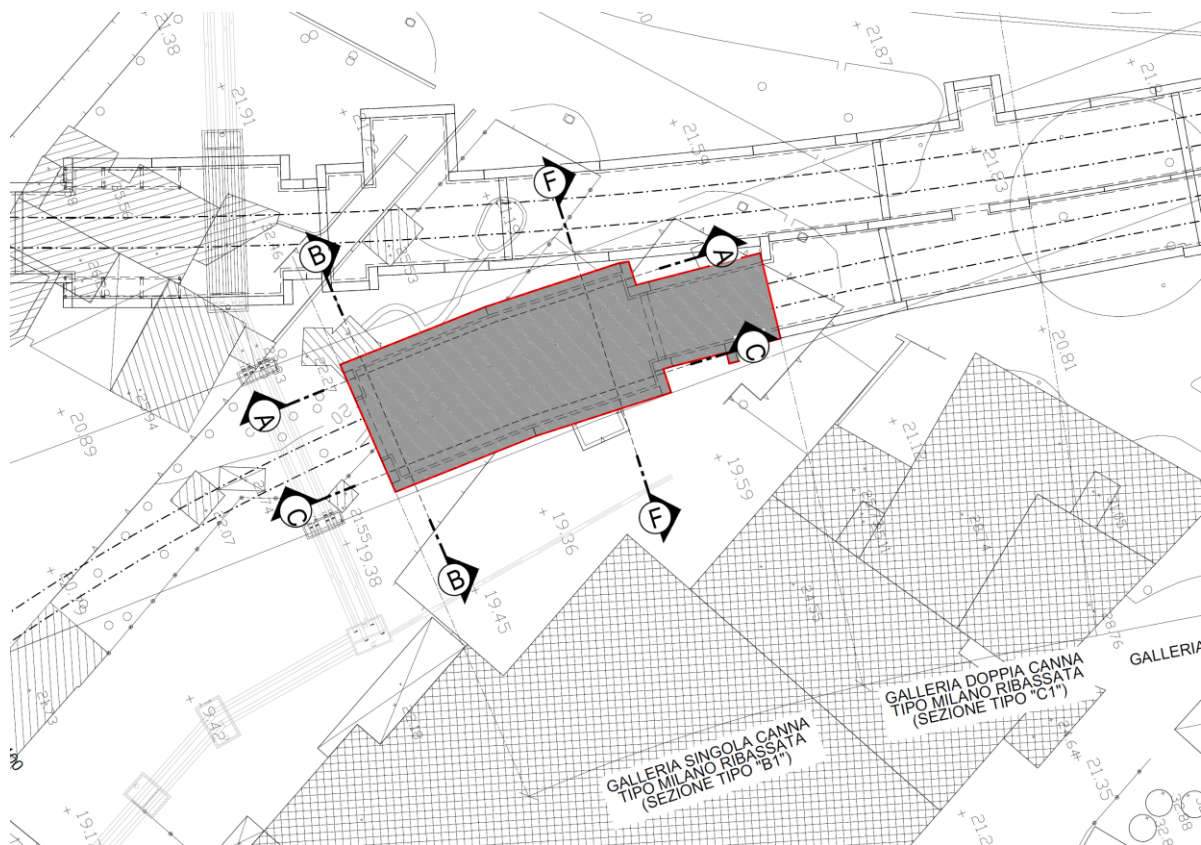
Planimetria di inquadramento tratta – Stato di Progetto di Variante
